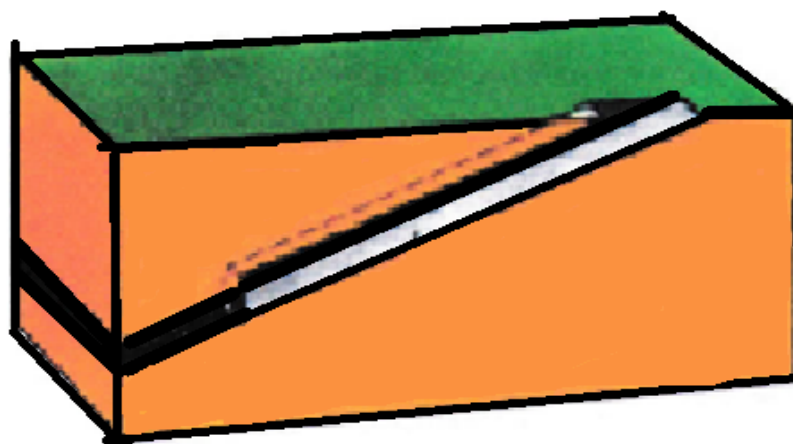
Вскрытие угольного пласта наклонным стволом
